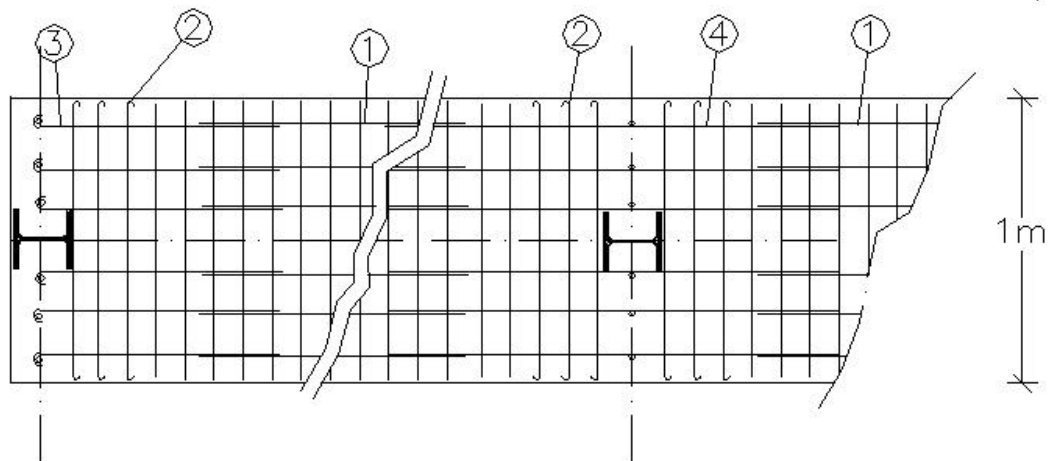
b/ Armaturage de la dalle et ancrage à la poutre transversale
